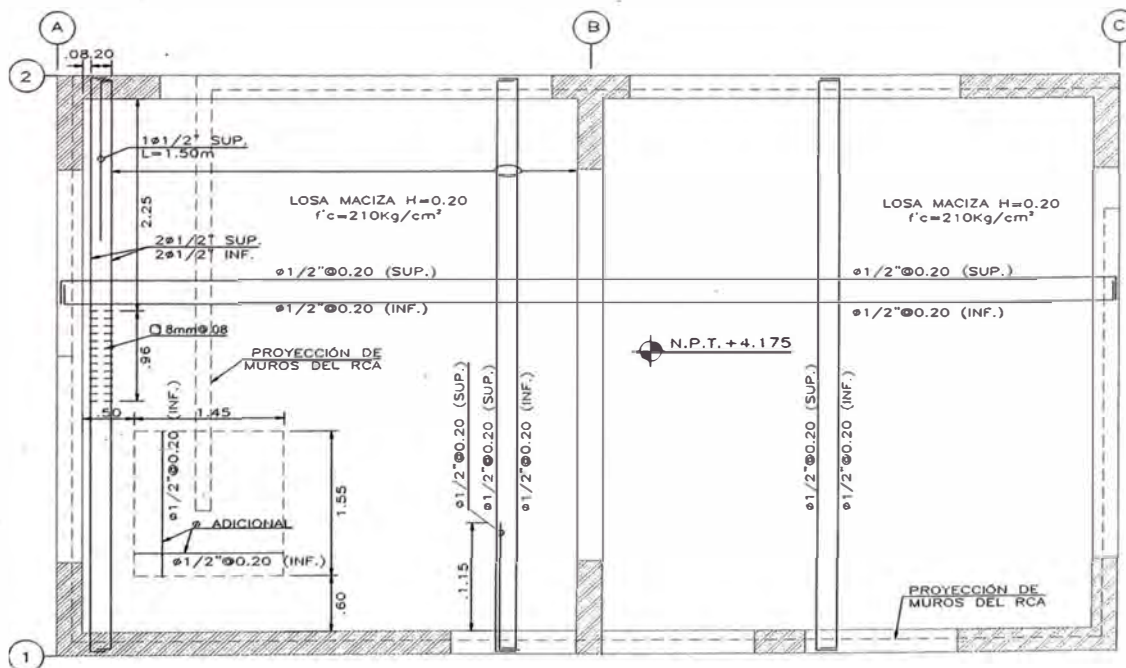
Distribución del refuerzo en la losa maciza.
